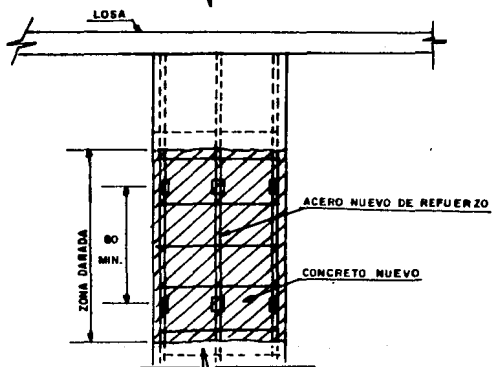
SUSTITUCION DE CONCRETO EN COLUMNAS (REPARACION TIPO II)
